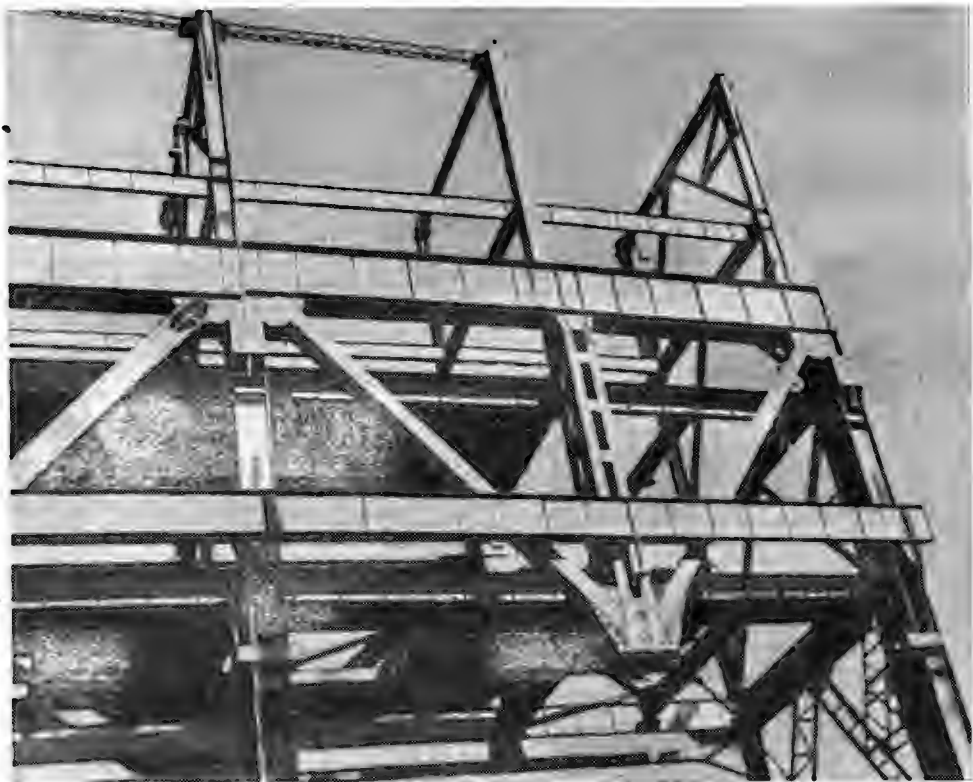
Подкрановые фермы с двухъярусным расположением подкрановых путей
